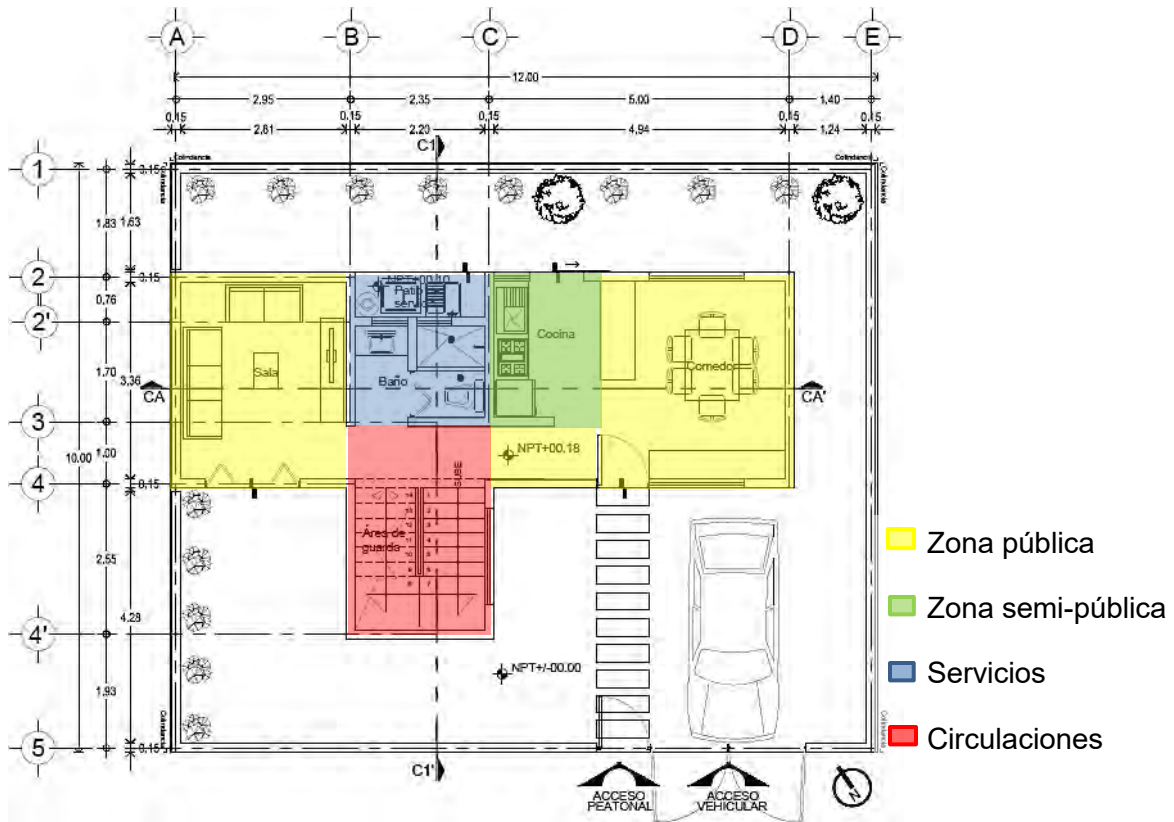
Planta arquitectónica de prototipo de vivienda C2. Segunda etapa, planta baja.
